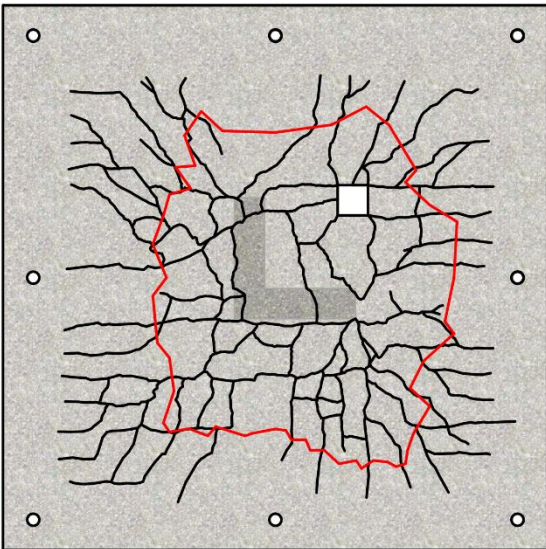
Padrão de fissuração da laje L3
